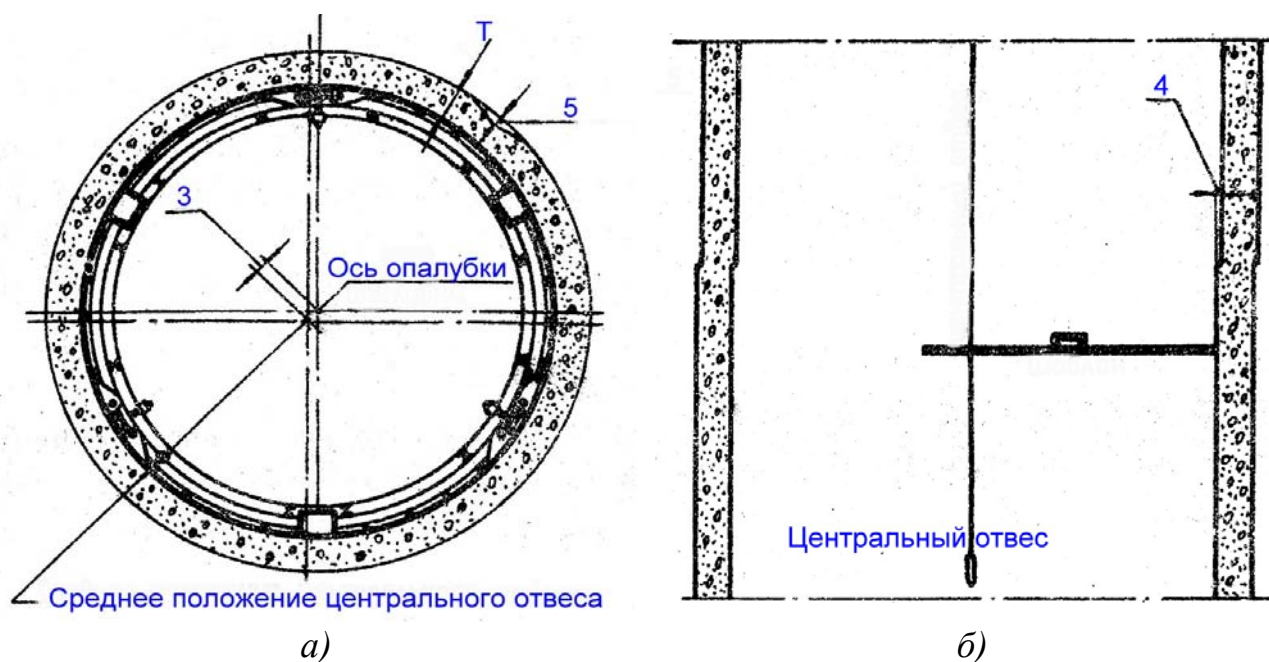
Допустимые отклонения при возведении бетонной (железобетонной) крепи ствола
